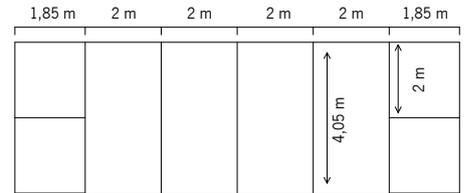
Planta da camada de polietileno inferior - 1/150
